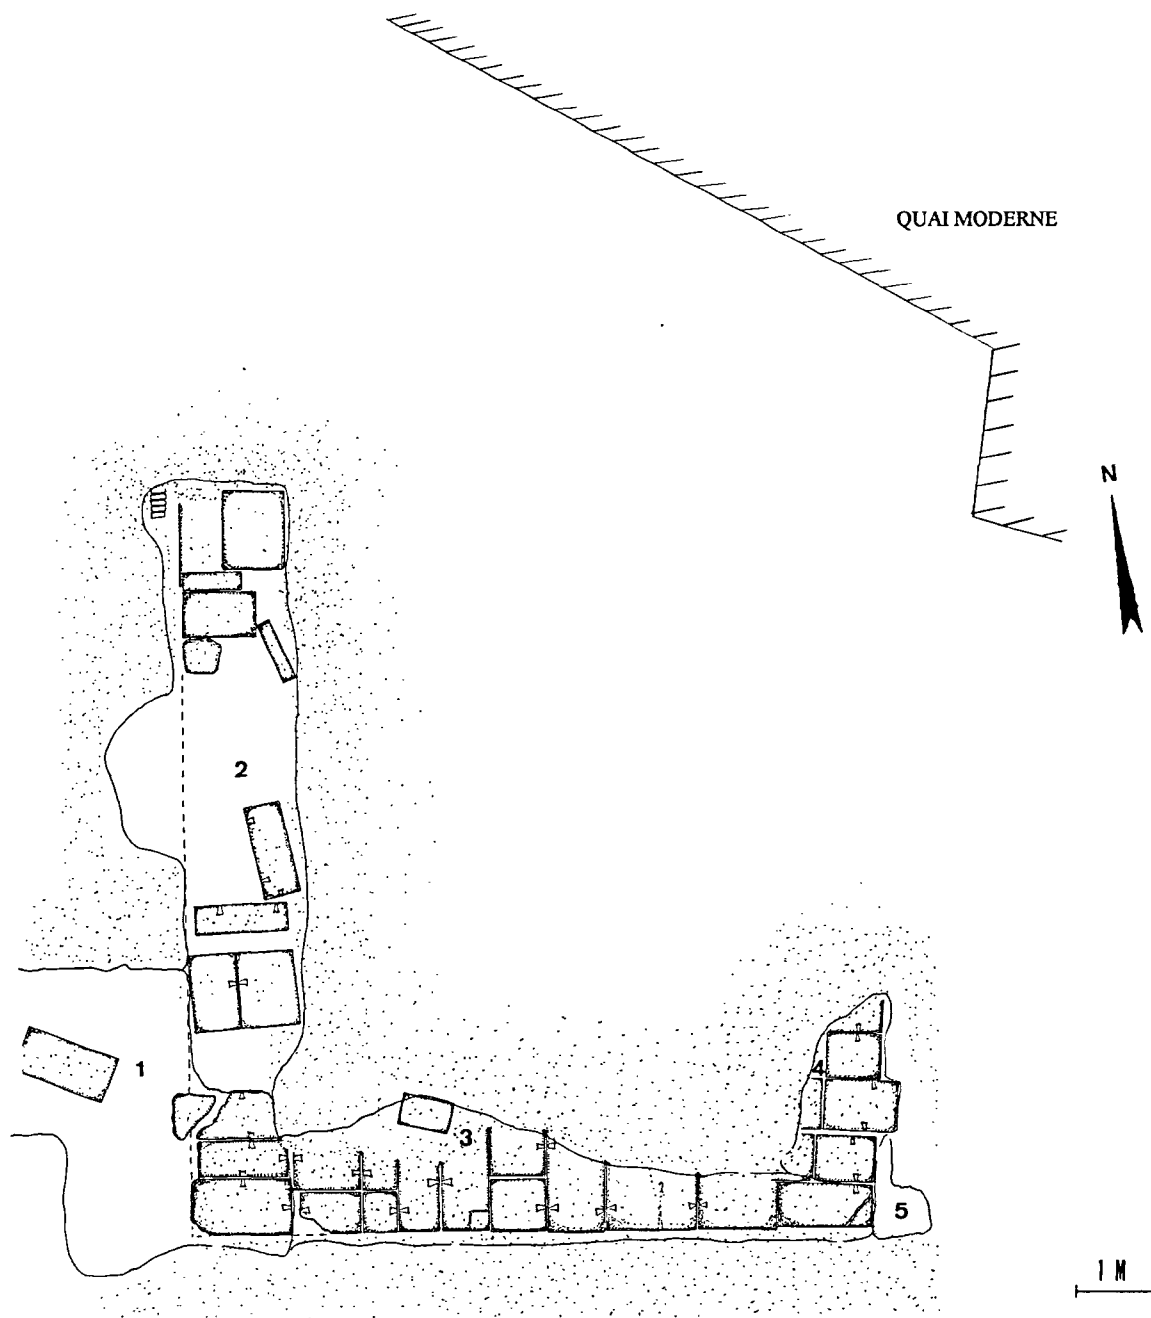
Port-la-Nautique. Plan d'ensemble, position des sondages (éch. 1/10).
